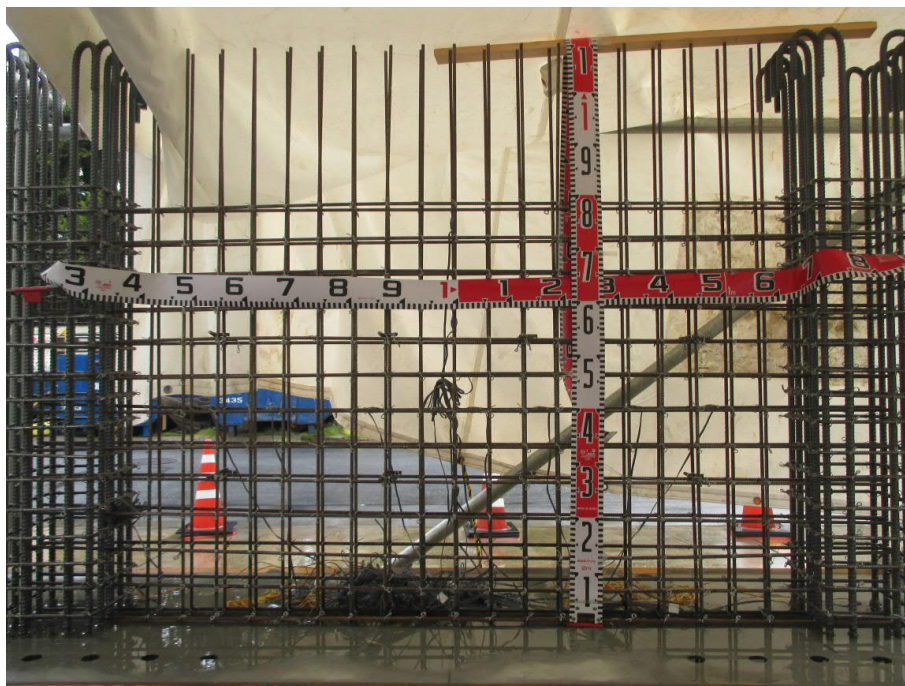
1-5 試験体 T100-p10-D6-W の壁配筋状況
